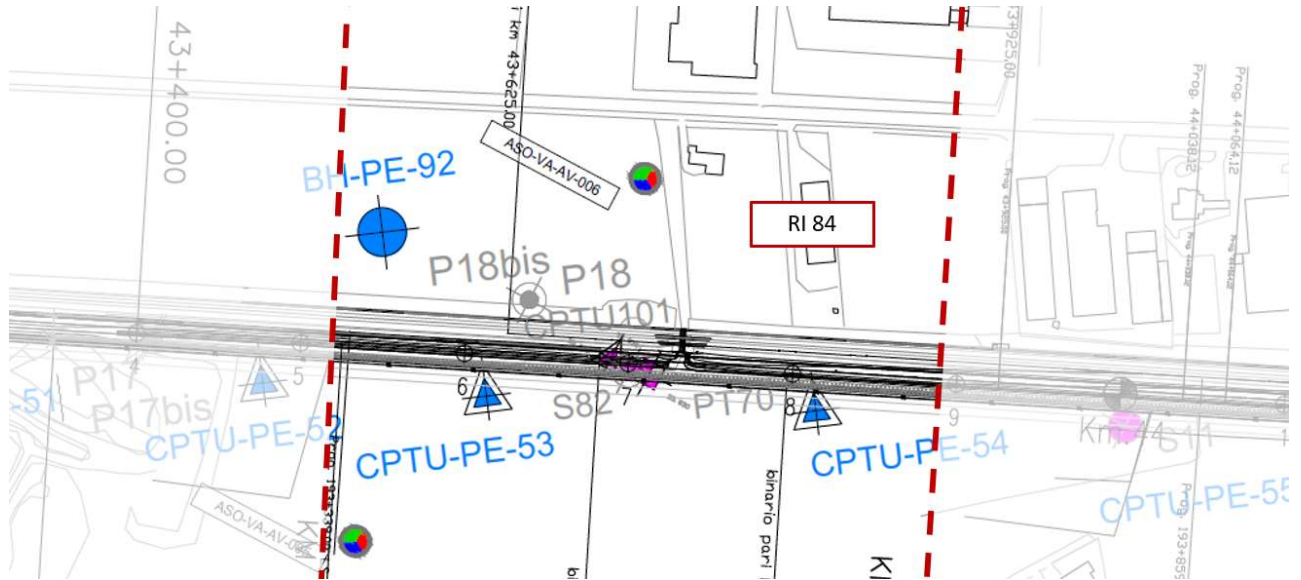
Planimetria Rilevato RI84, estratto dalla Planimetria Generale (Doc. Rif. [3])
